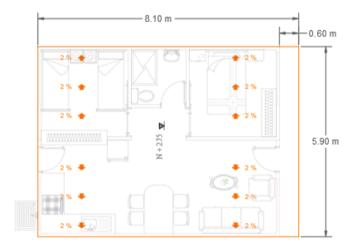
Dimensiones de la losa de cubierta de la vivienda mínima modular.
